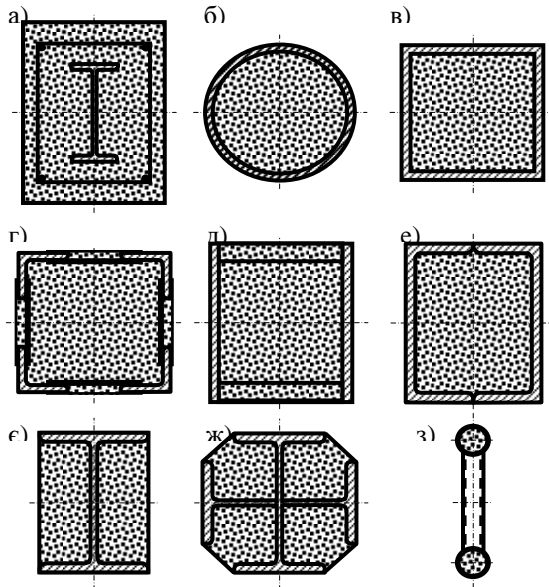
Поперечний переріз сталезалізобетонних стрижневих конструкцій: а) із внутрішнім жорстким армуванням; б), в) трубобетонні з круглих і квадратних труб; г), д) із кутниками й листами вповдовж граней; е), е), ж) у вигляді сталевих профілів із заповненими бетоном міжпоясними порожнинами; з) складені зі сталезалізобетонних гілок
